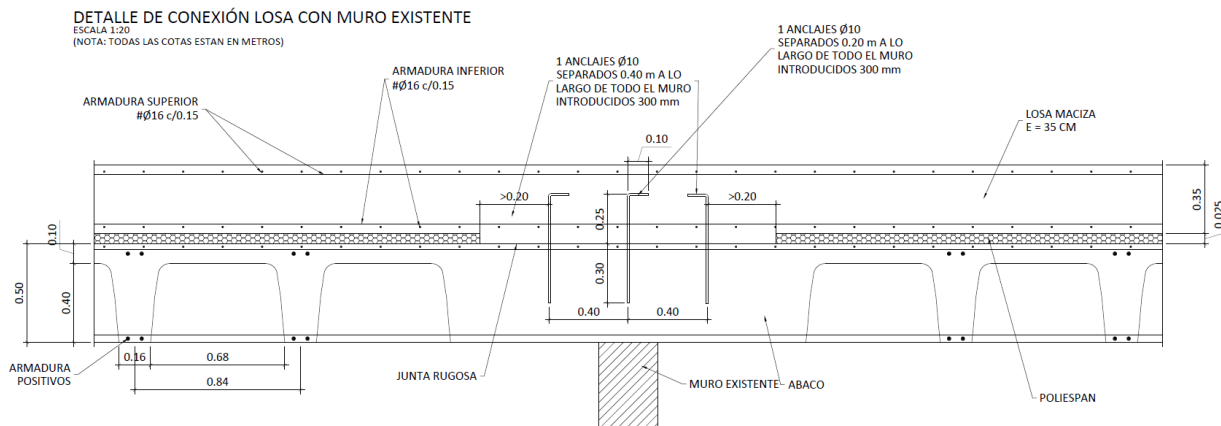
Detalle conexión losa de 35 cm con muro existente. Fuente: Proyecto instalación de parque Multiaventura sobre forjado del centro comercial LAGOH en Sevilla
